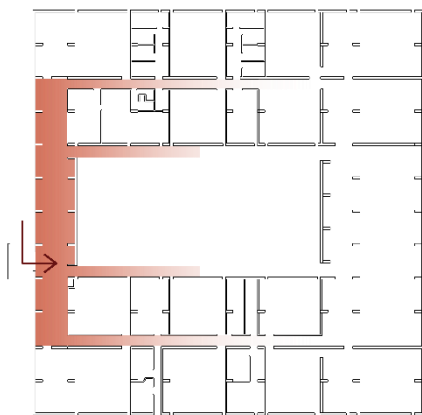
Planta para as Escolas de Arte e Arquitetura de Chandigarh com a circulação principal indicada em vermelho.
